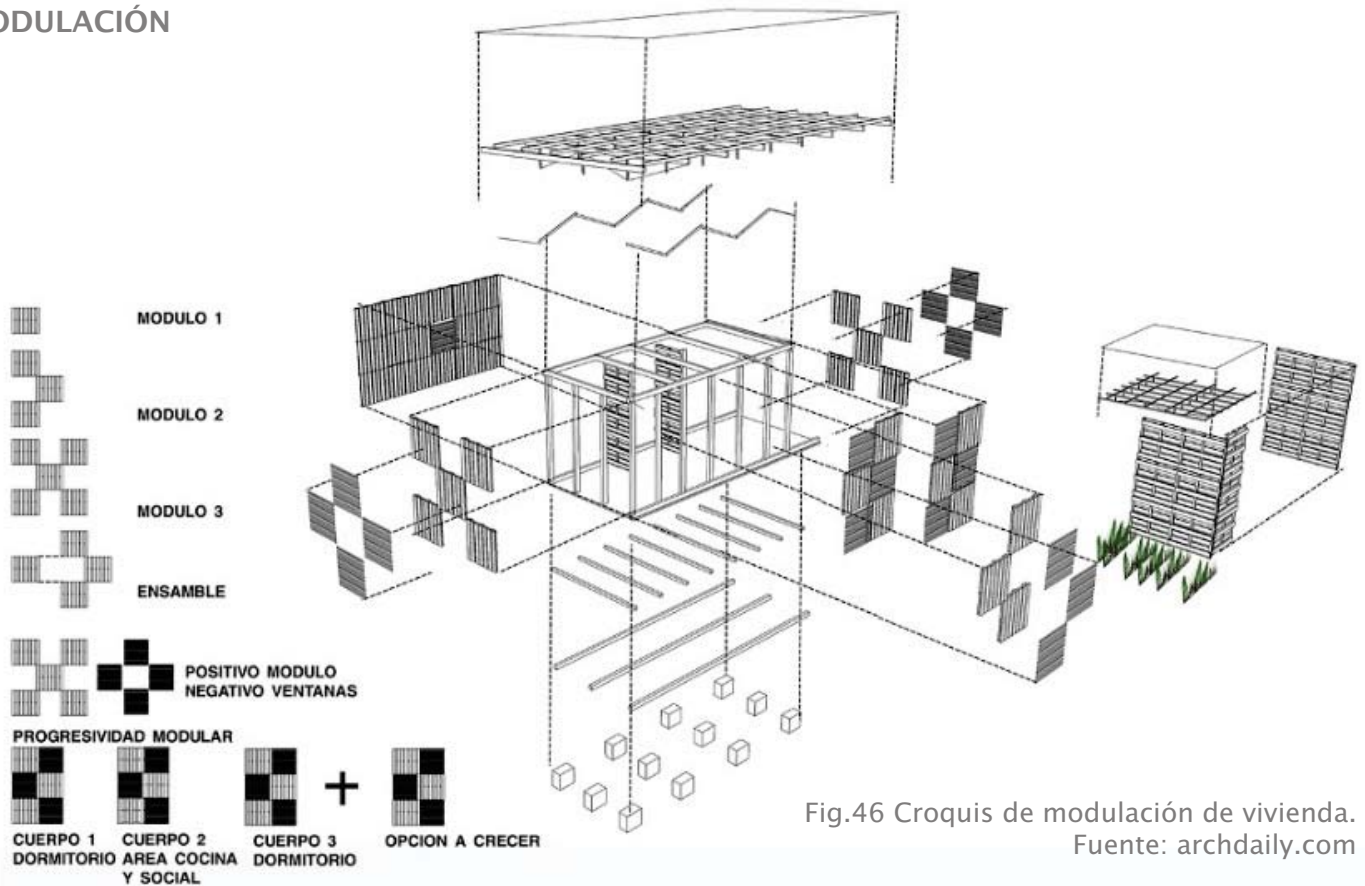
Croquis de modulación de vivienda. Fuente: archdaily.com
